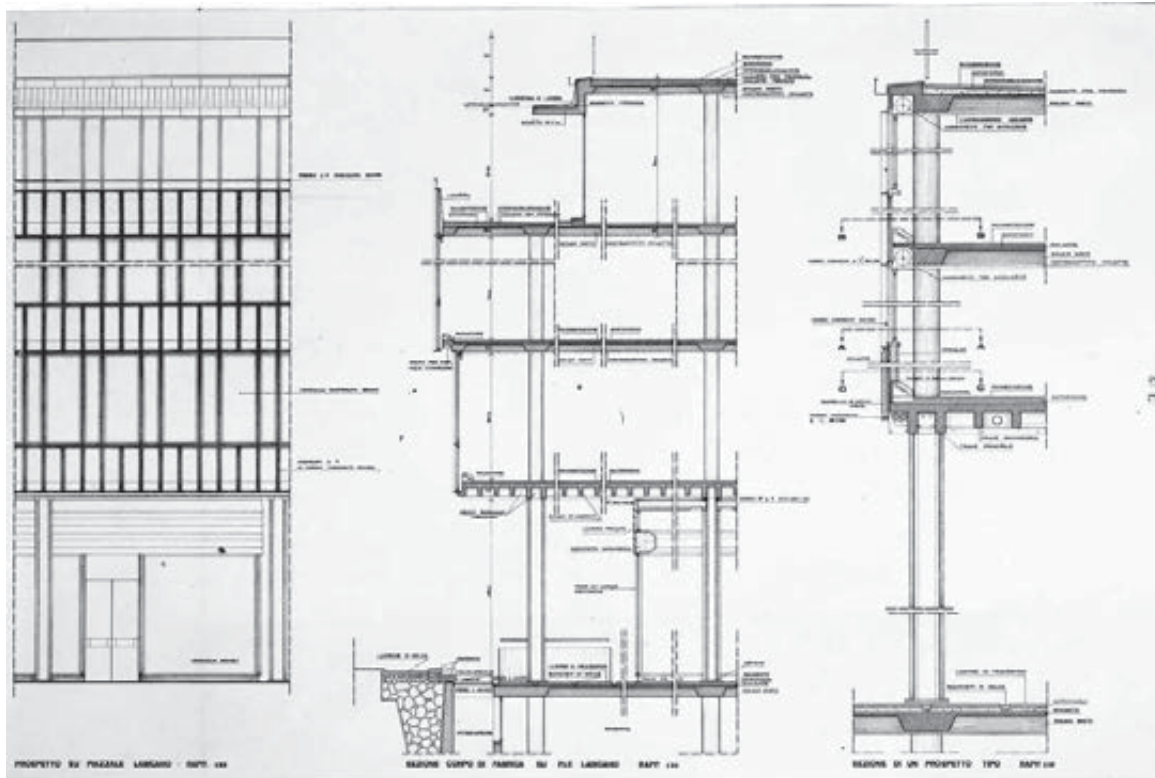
Particolari della facciata in prospetto e sezioni (ACS, FL, ID 4420, Documentazione lastre fotografiche, b. 73, UA 00135, sf 12, Roma Pantanella)
